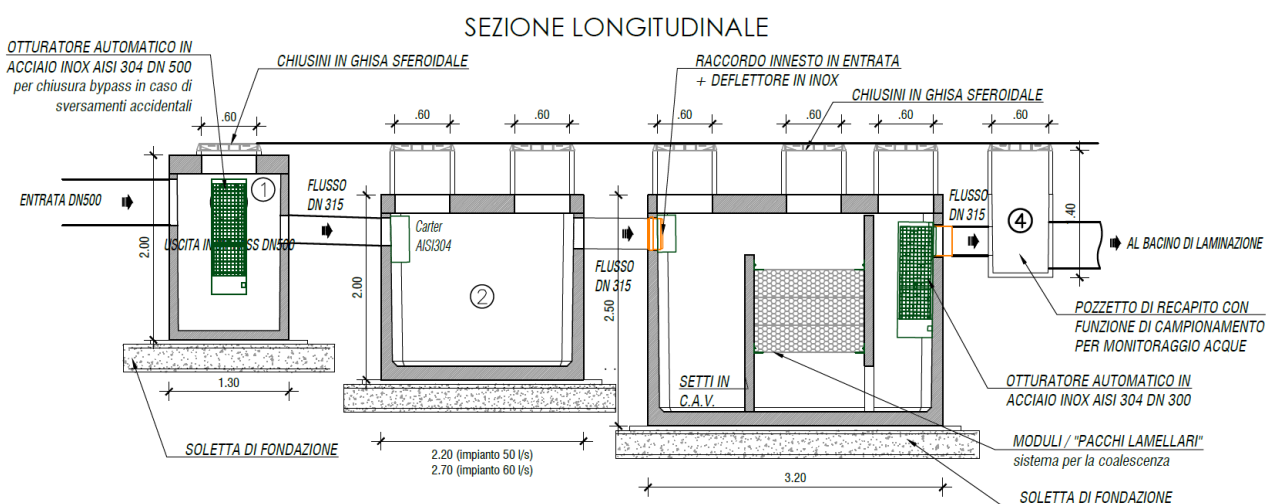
Sezione tipo – Impianto di trattamento AMPP
